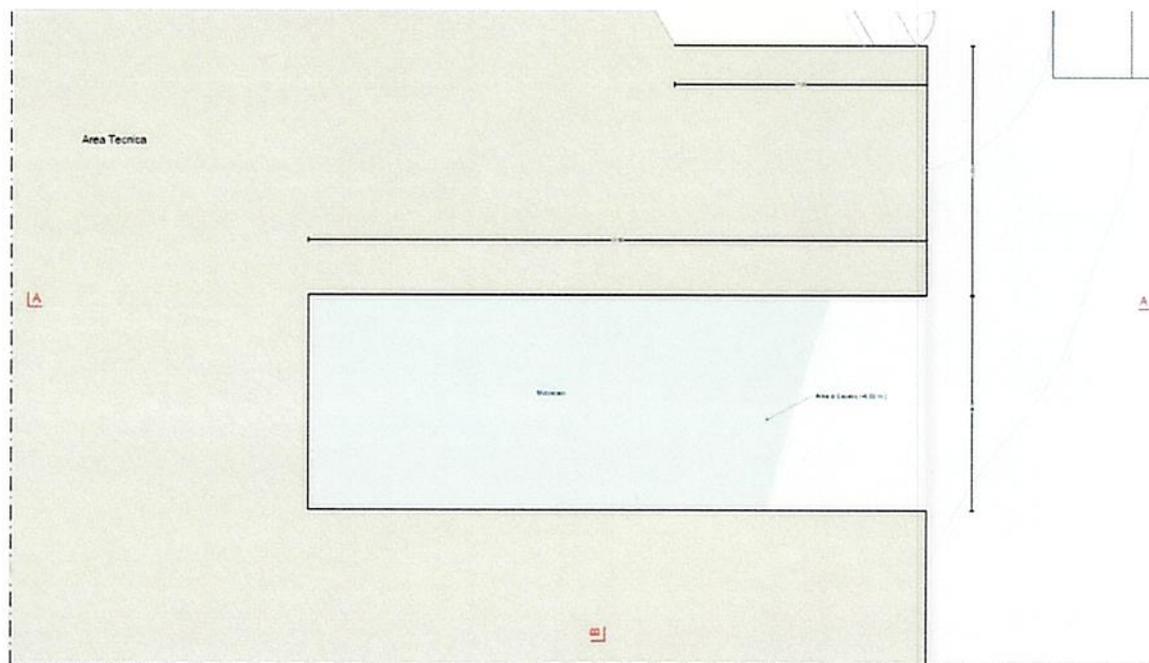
pianta moto scalo (tav. EG\_OMI 10\_0)
